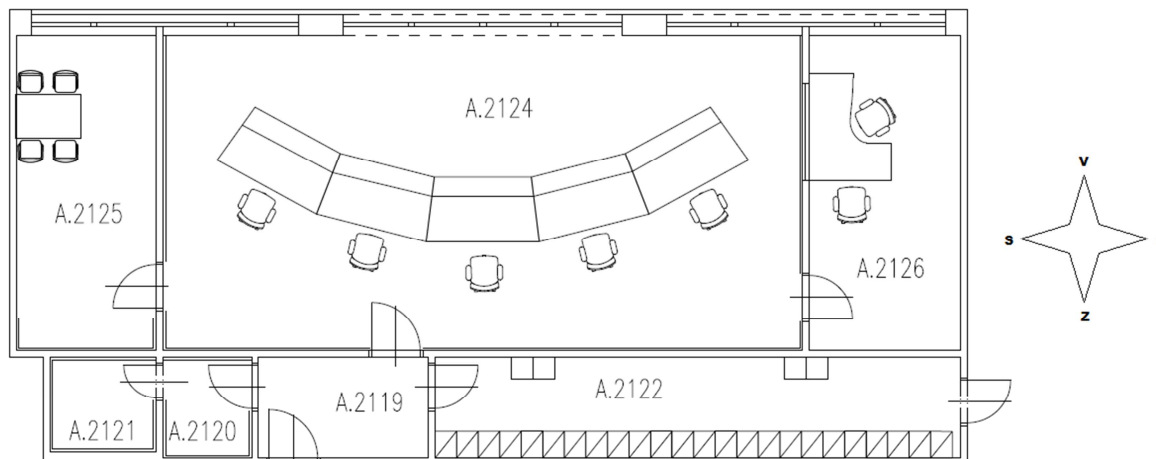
Půdorys objektu ZZS ZK s vyznačeným dispečerským pracovištěm
